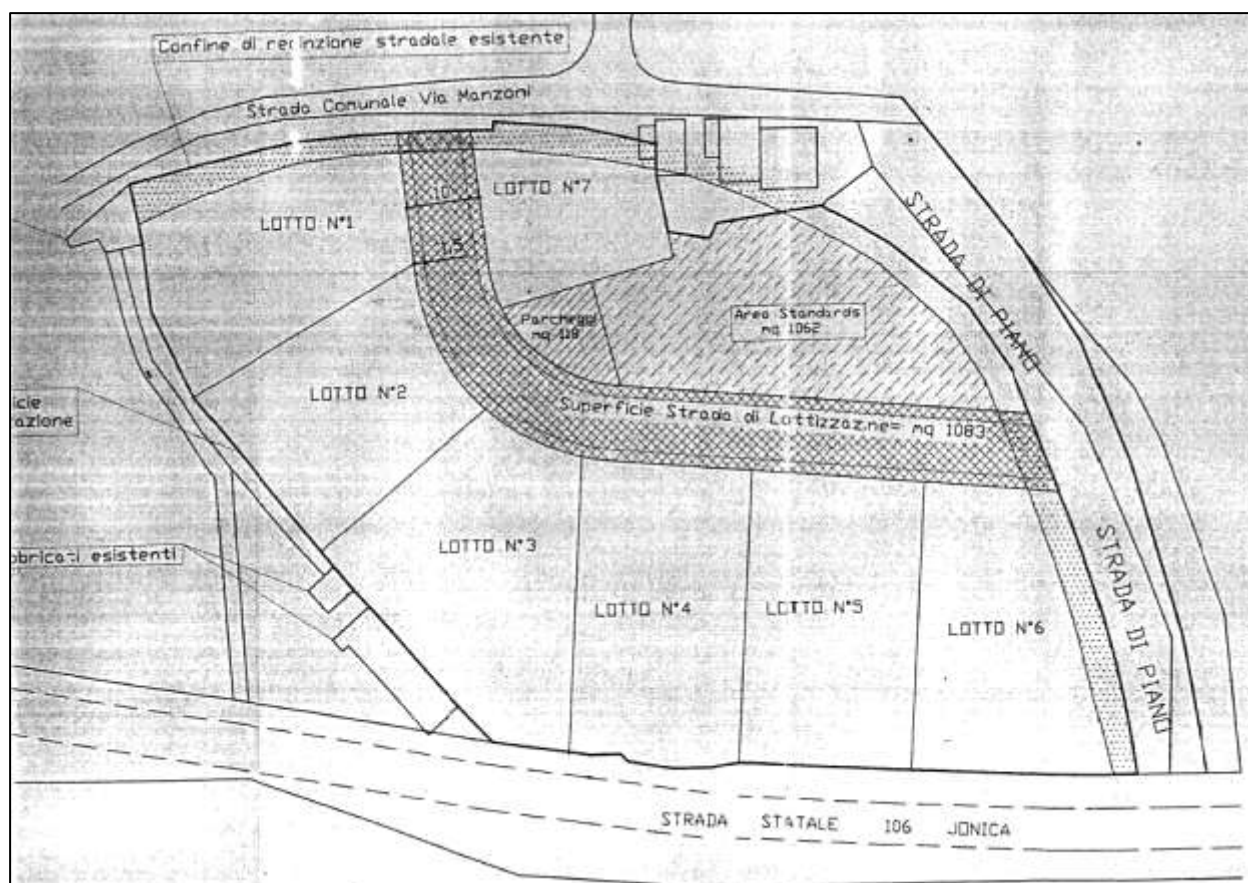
Planimetria Piano di Lottizzazione - Individuazione lotti
